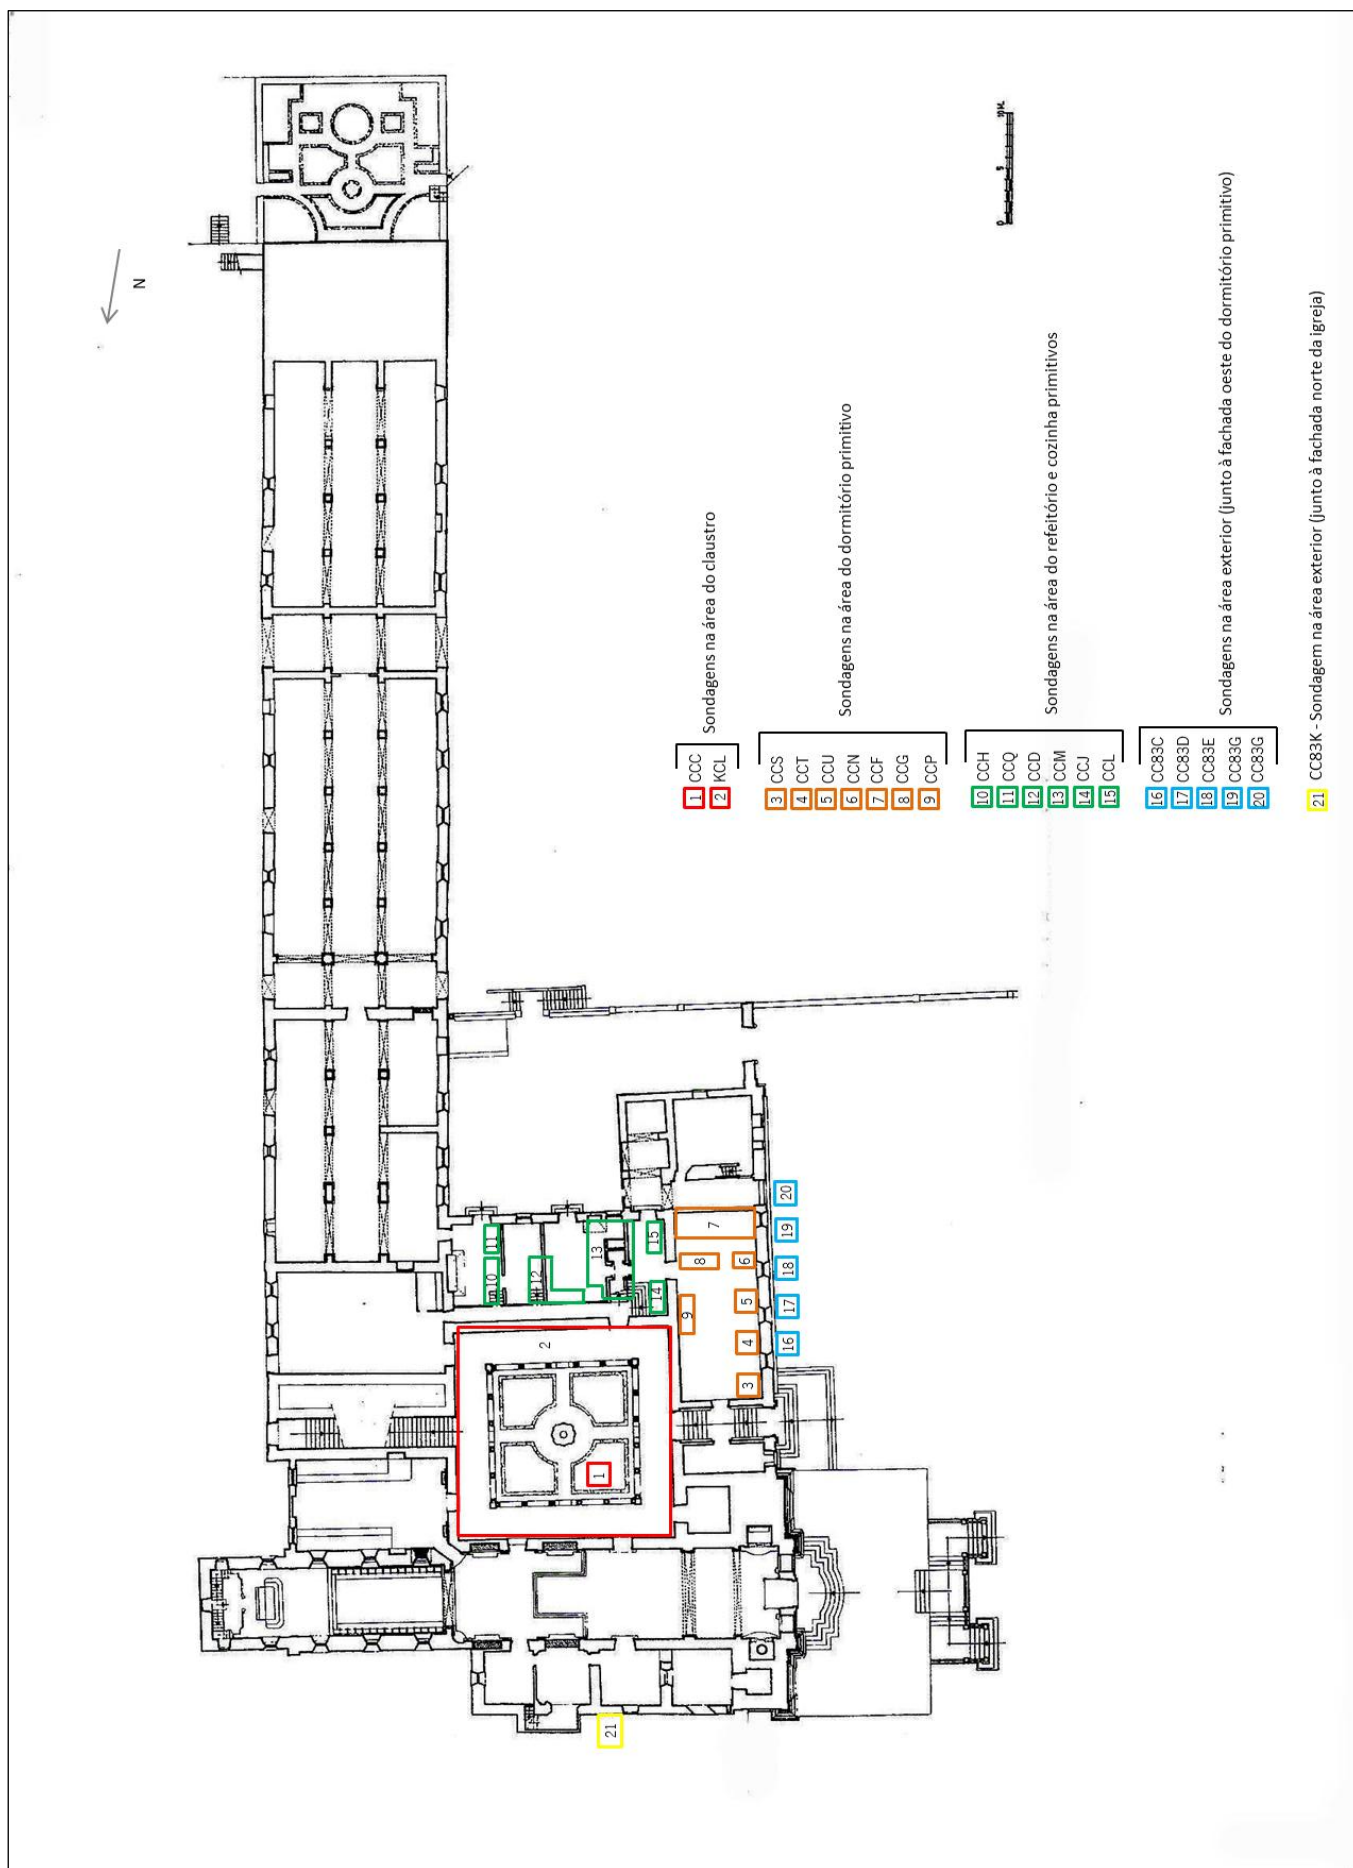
Planta do mosteiro (antes das obras de restauro). *Boletim nº130
